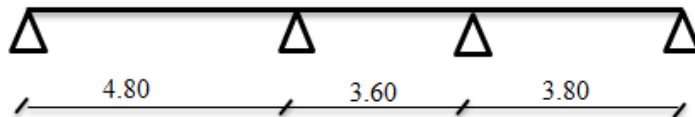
Poutrelle type 05 (Plancher Sous-Sol -usage commerciale-)
